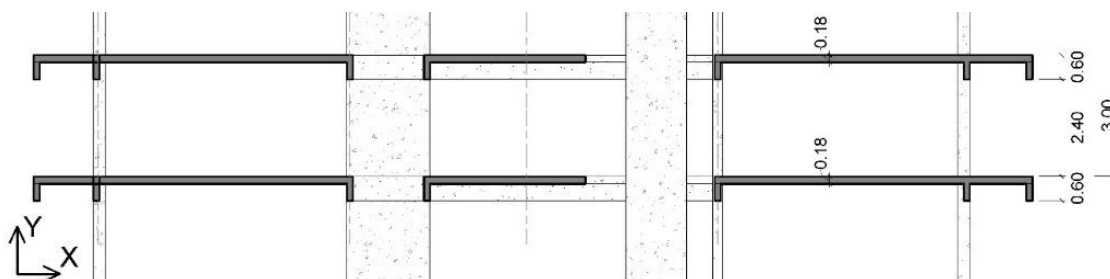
Corte A - Pavimento tipo – Modelo H = 90m - Unidades em metro.
